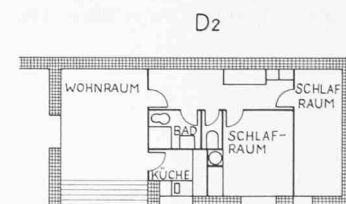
Grundriss 1:300 eines kleinen Dreizimmerhauses Typ D2 «Les Fourches». Die in der Perspektive (Bild 7) gezeigte Sonnenterrasse ist vom Wohnraum aus zugänglich
